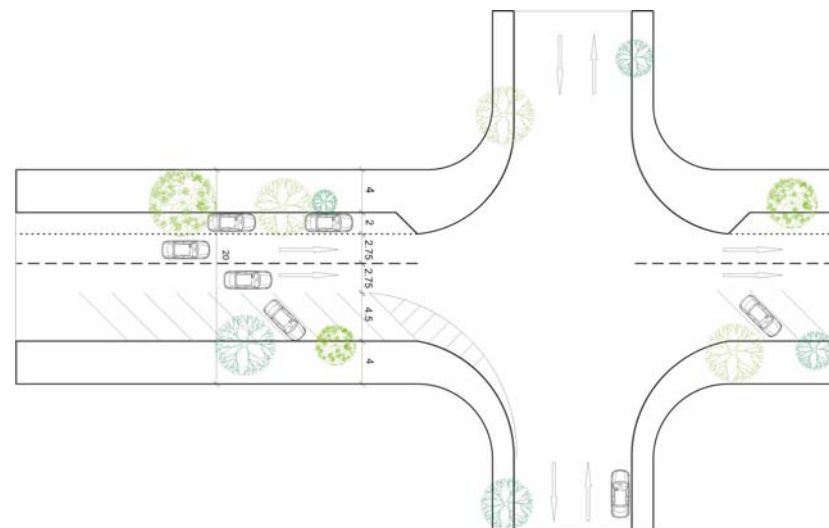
Esquema proposto para Av. Rio de Janeiro
